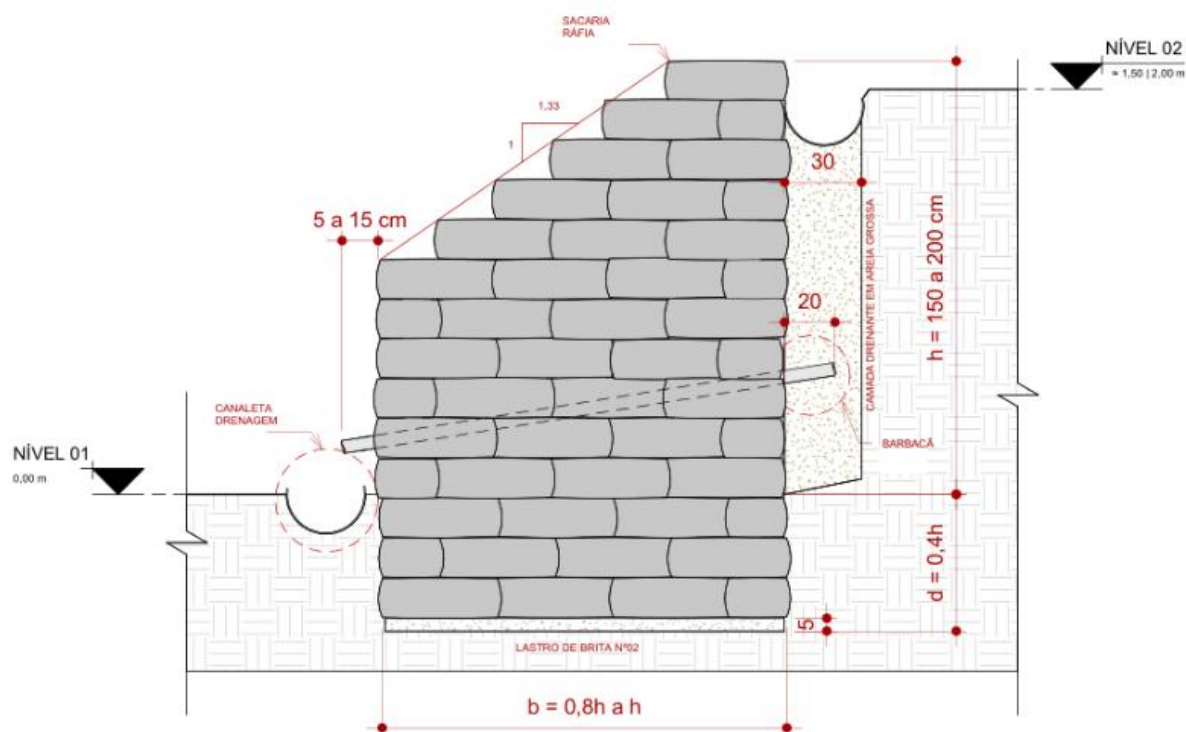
Detalhes construtivos da solução de muro de solo-cimento.
